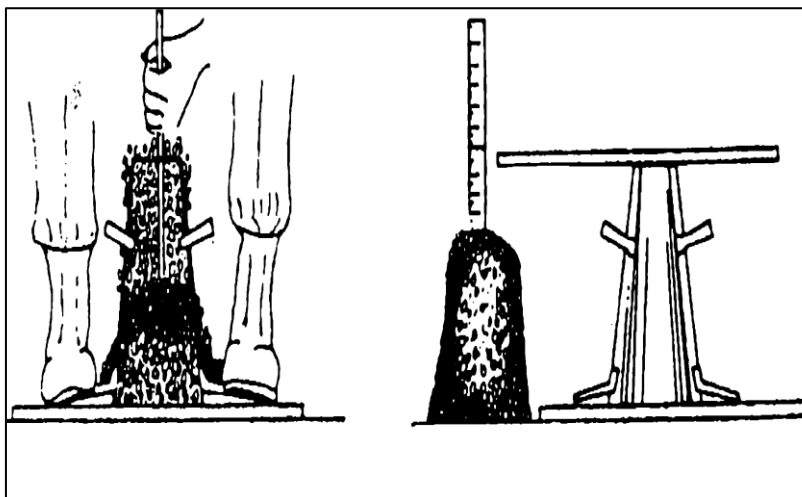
Equipo de ensayo de asentamiento del Concreto
